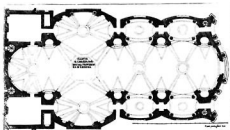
Planta de Sta. María de la Divina Providencia (Guarini).
